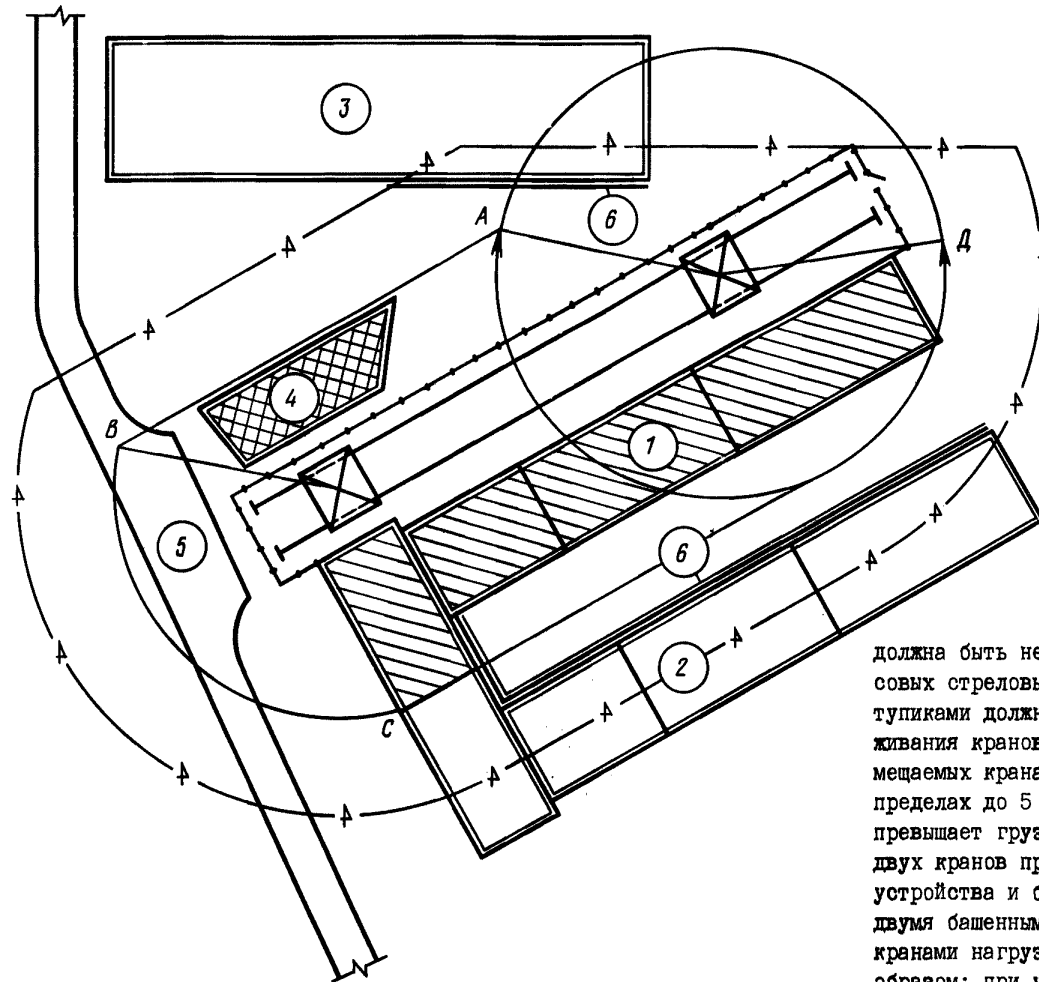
Ограничение зоны работы крана при организации строительной площадки:
